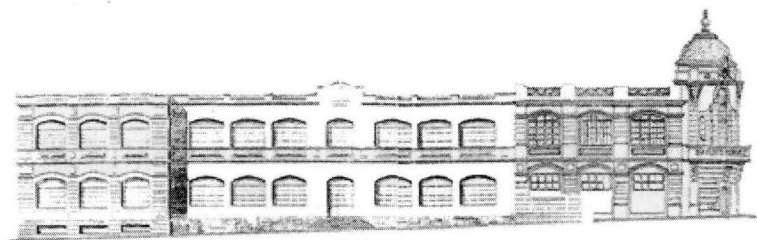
Alzado planta nueva yuxtapuesta a la anterior existente.
